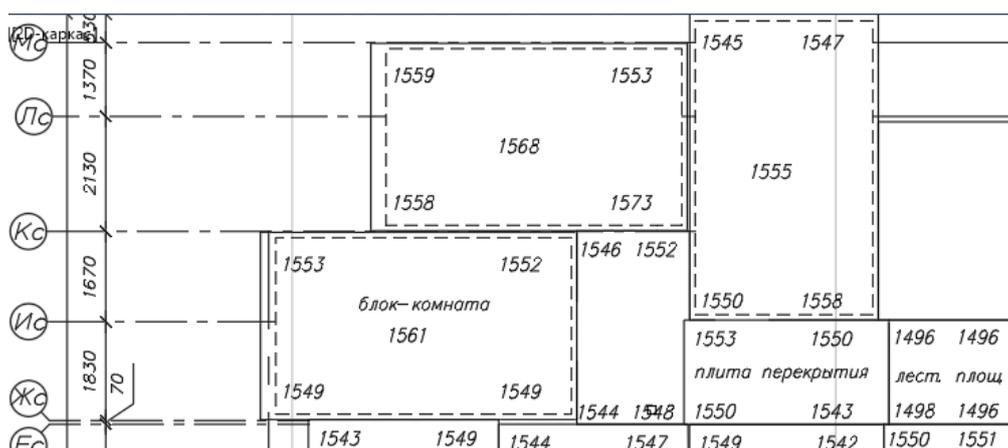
Фрагмент высотной съёмки блок-комнат и плит перекрытия
